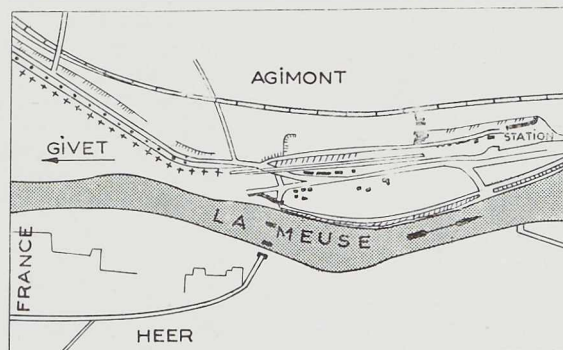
Plan de situation. (Echelle 1/20.000.)
